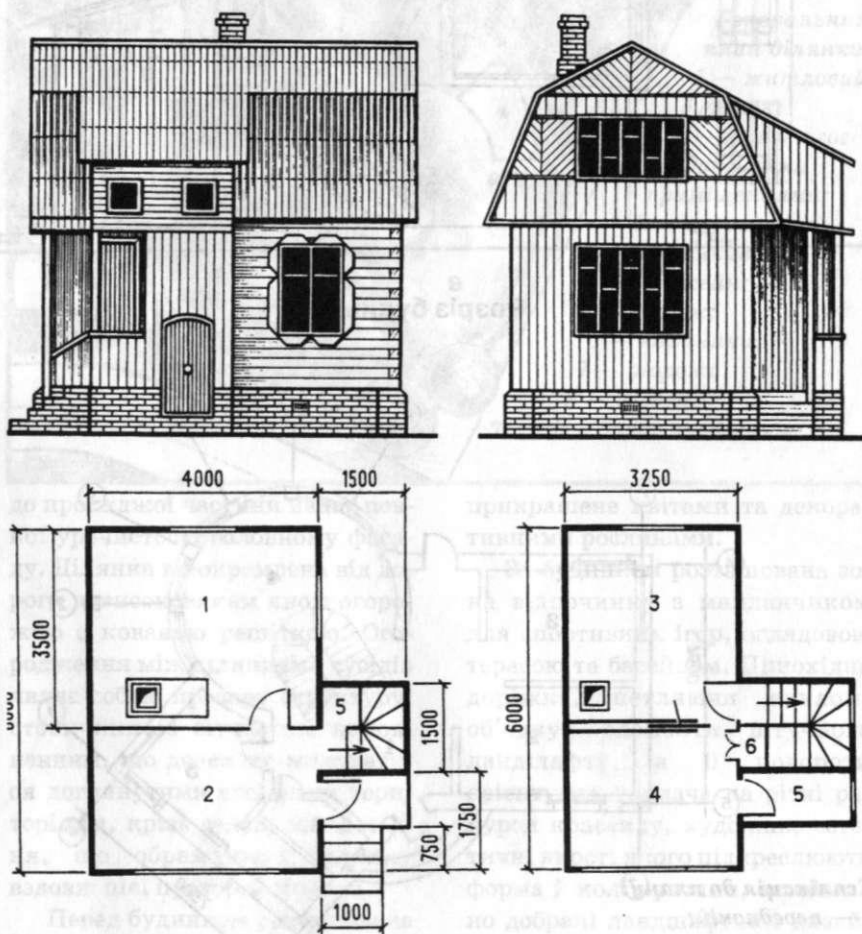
Фасади й плани будинку: 1 — опалювальне приміщення, 2 — веранда, 3 — кімната мансарди, 4 — застлана лоджія, 5 — комора, 6 — вбудована шафа
